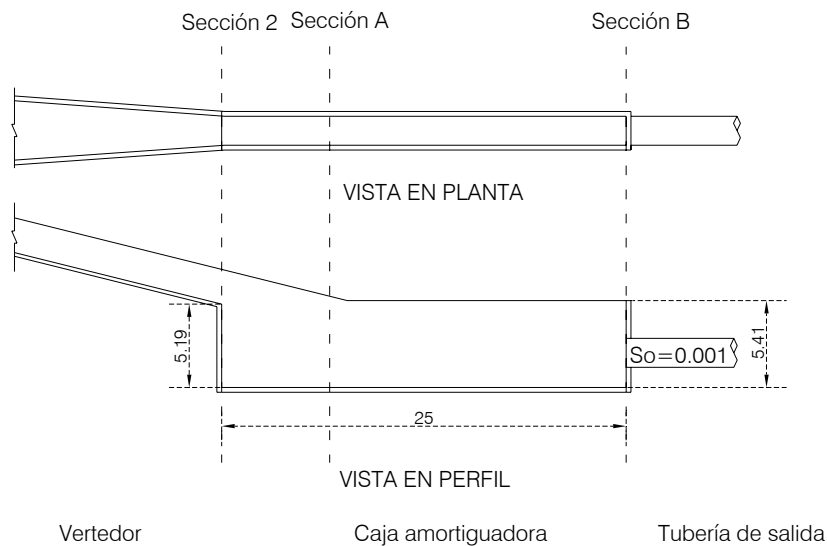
Vista en planta y de perfil de la caja amortiguadora
